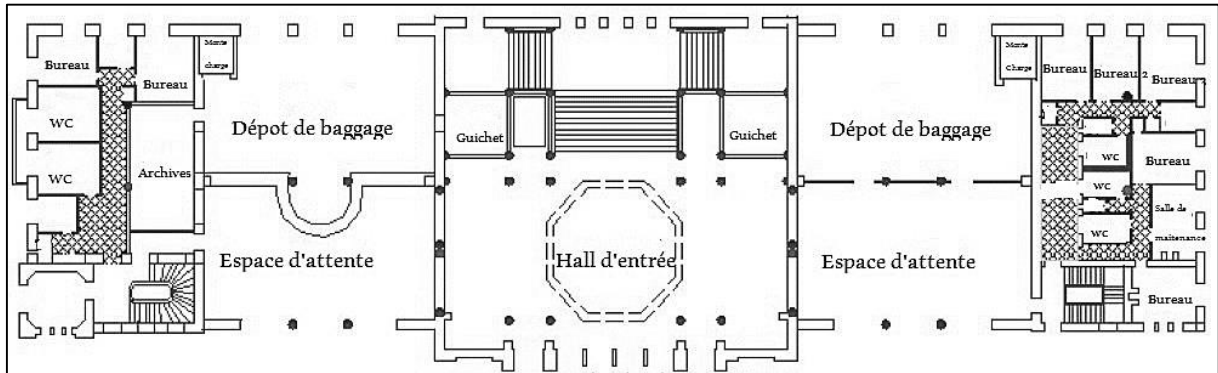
Plan du Rez de chaussée de la gare ferroviaire de Skikda
